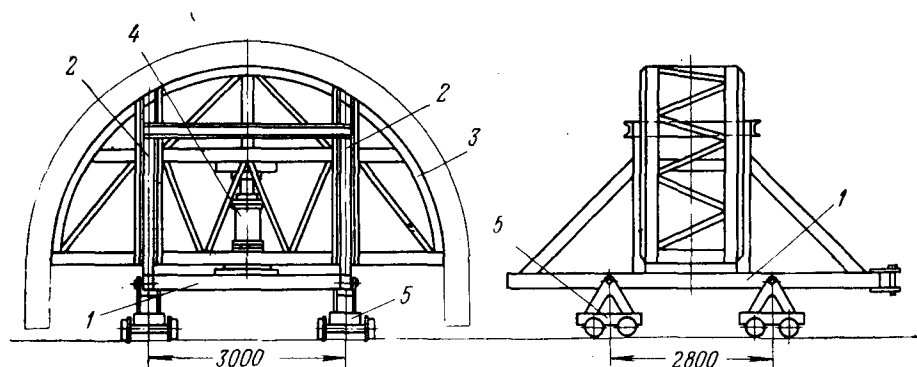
Платформа-крепеукладчик сборной железобетонной крепи устья стволов: 1 — нижняя опорная рама; 2 — направляющие неподвижные фермы; 3 — верхняя подвижная ферма; 4 — гидравлический домкрат с пневмоприводом; 5 — опорная тележка
